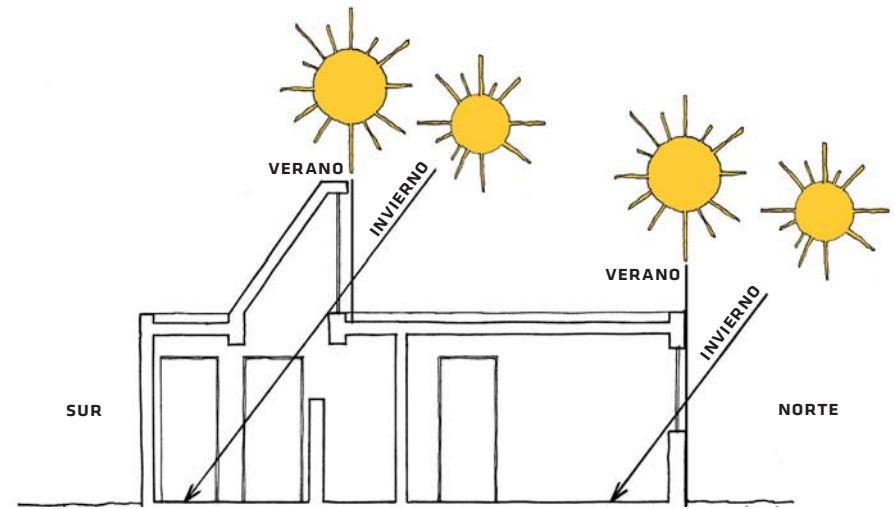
Vivienda en San Pedro de Atacama (23,5°S), 2300 m de altura. Detalles en Lavigne, Pierre (2003)⁴
